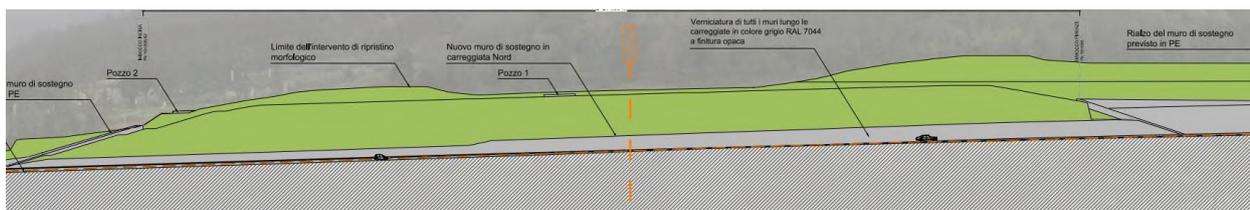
Prospetto nuova carreggiata sud: muro di sostegno molto ridotto in altezza
